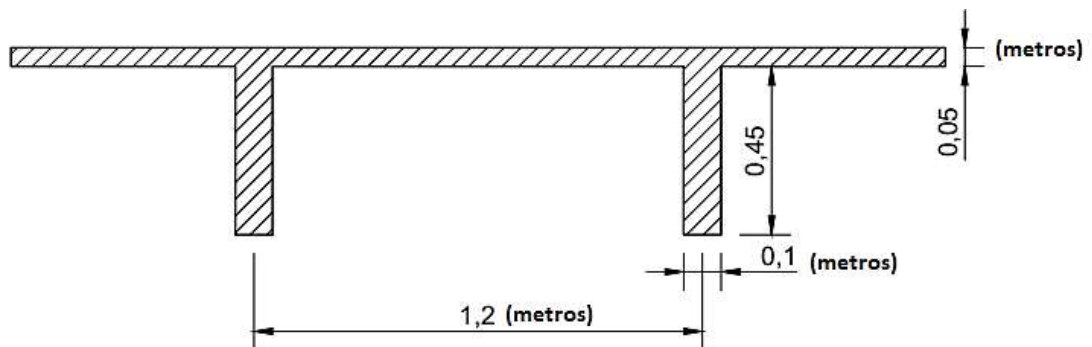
Losa nervada – Placa de entre piso, rampa Peatonal y Vehicular.
